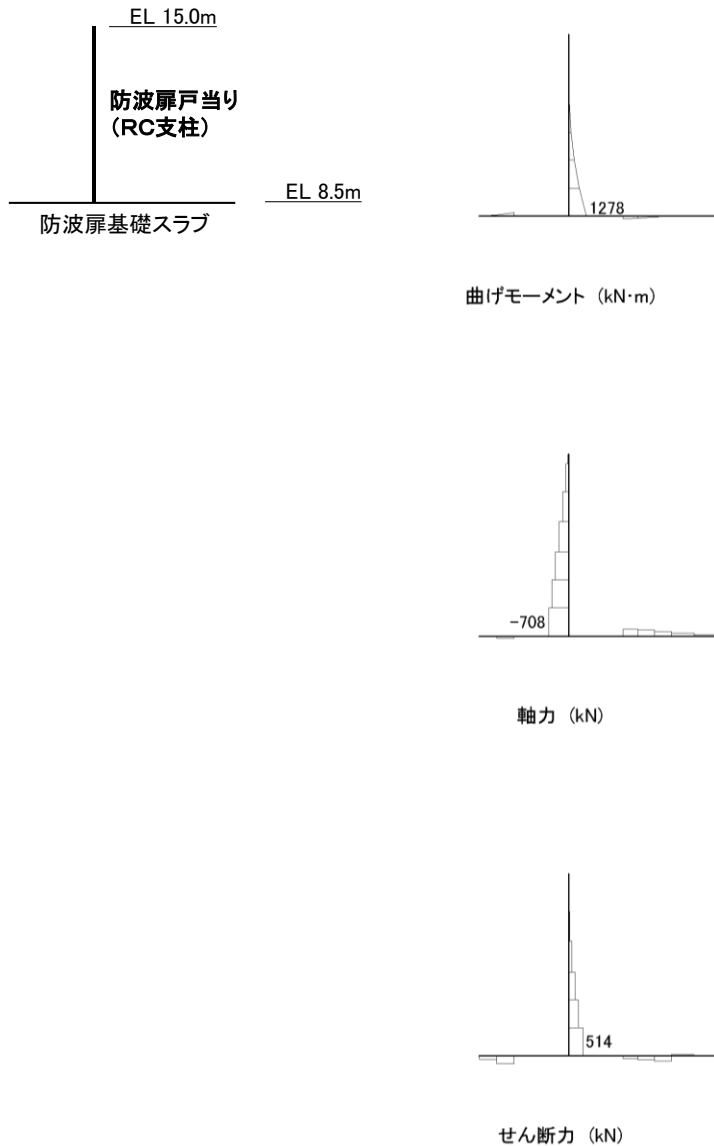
コンクリート及び鉄筋の曲げ・軸力系の破壊に対する照査断面力図
